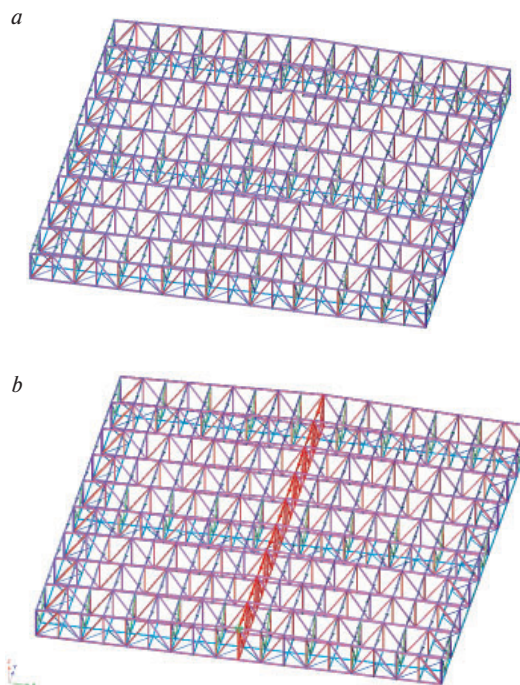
Расчетная модель покрытия при шаге ферм 12 м: а – со шпренгельными прогонами; б – со шпренгельными прогонами и дополнительной вертикальной фермой
